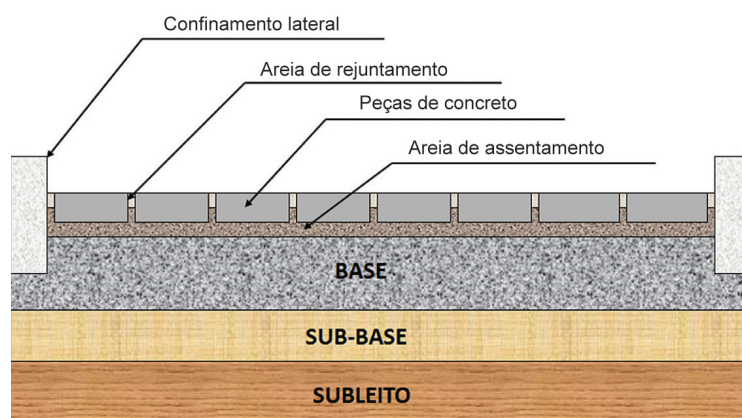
Seção Típica de Pavimento Intertravado (ABCP, 2010)
